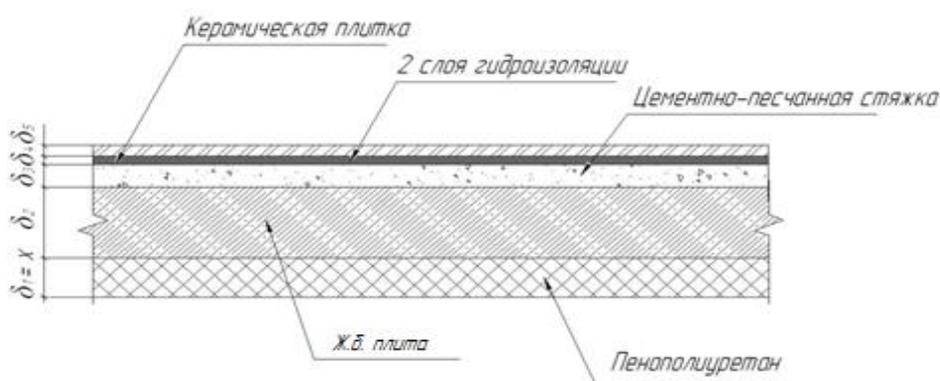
Состав конструкции перекрытия над подвалом
